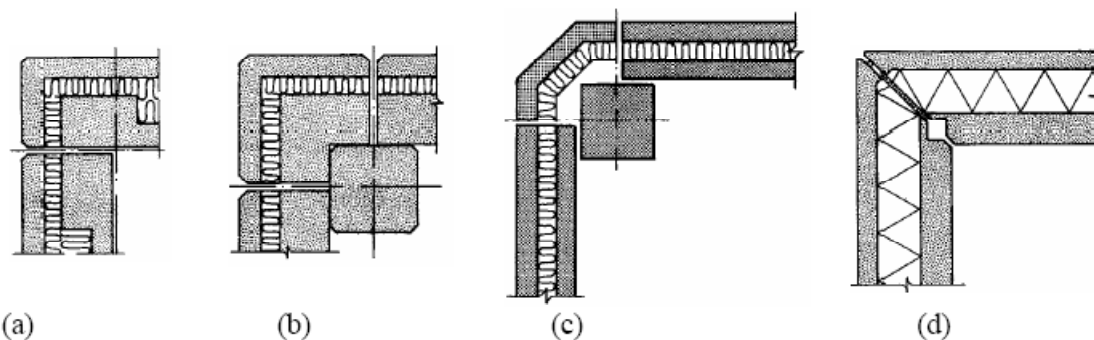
Soluções para cantos de fachadas: (a) painel com canto integrado, (b) e (c) elemento de canto separado, e (d) interseção de painéis em diagonais
